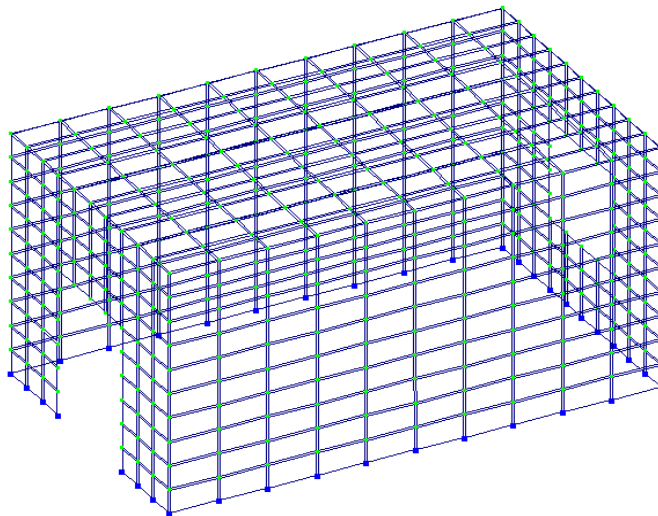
Розрахункова схема фрагмента будівлі в ПК «ЛІРА-САПР»
